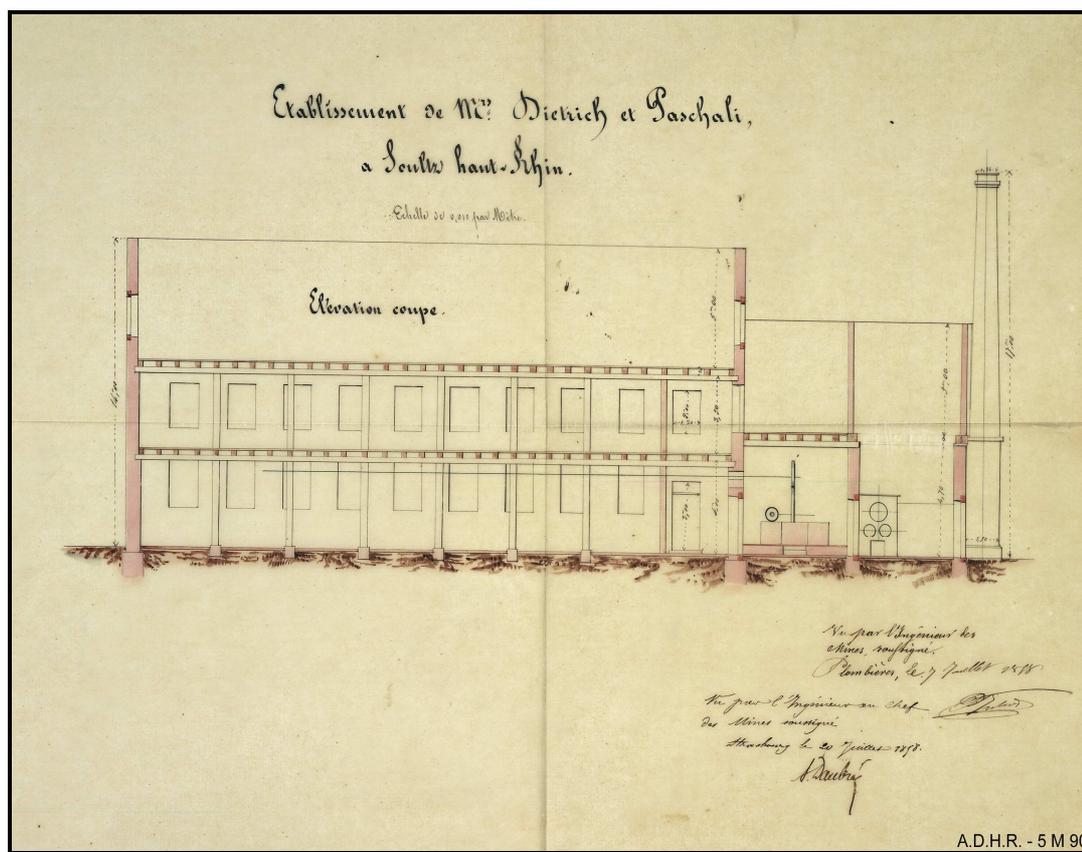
Plan en coupe de l'établissement Dietrich & Paschali en 1858 (source, ADHR, 5 M 90)
